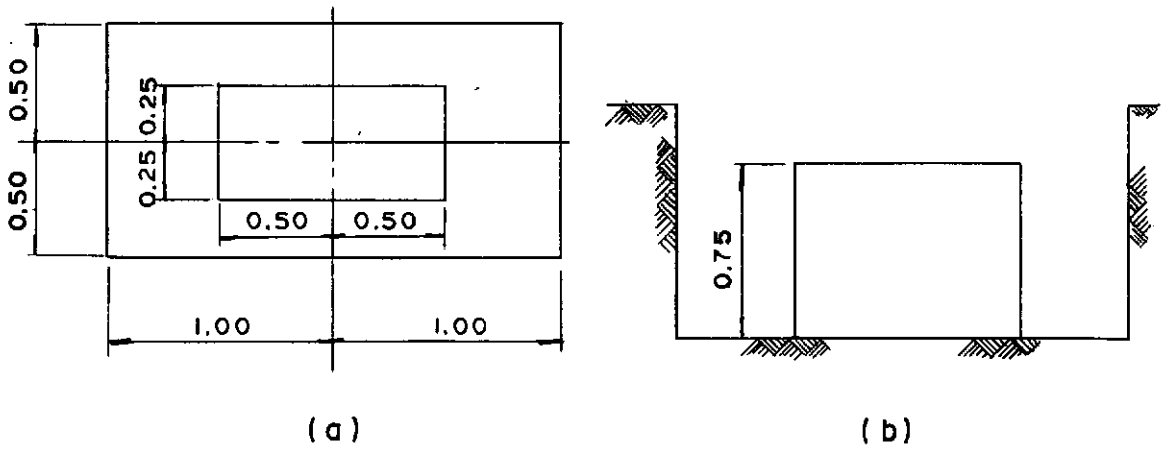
Bloco de ensaio e escavação: (a) Planta; (b) Seção.
